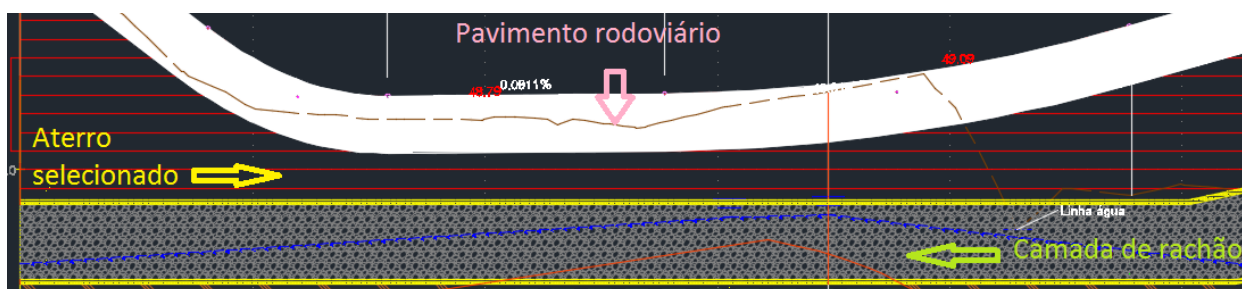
Perfil longitudinal do desnível existente entre o pavimento e a camada de rachão, após correção, de aproximadamente 25cm entre o Km 0+050 e o Km 0+087.
